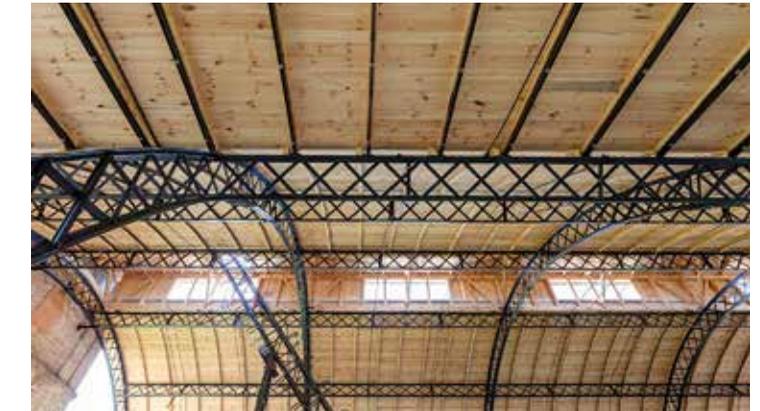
Blick in die sanierte Dachfläche mit der ertüchtigten Hallenkonstruktion, Mai 2021
